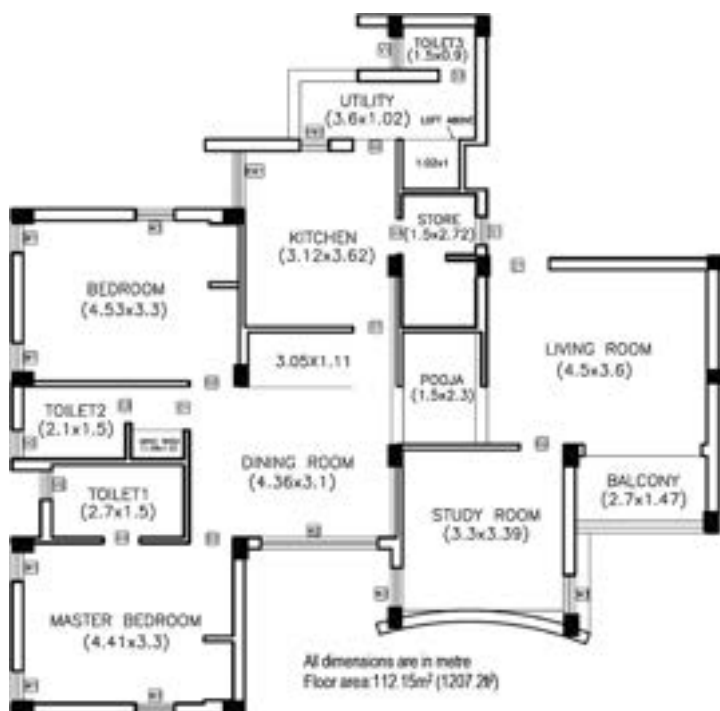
Planimetria edificio ad uso residenziale in India [37]
